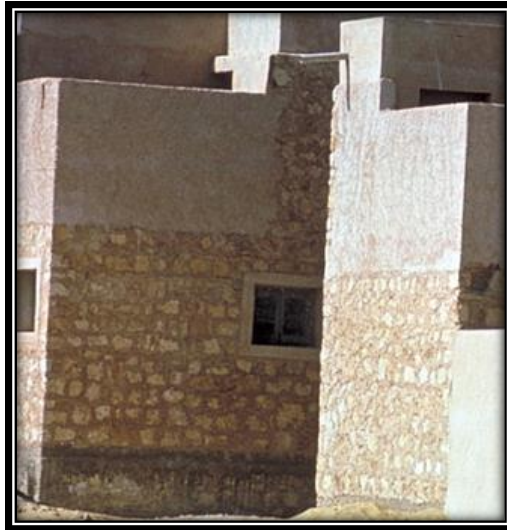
photo qui montre la pierre utilisée ;source André Ravéreau | ALADAR. Site officiel d'André Ravéreau. Consulté le 5 mars 2021, à l'adresse <http://www.aladar-assoc.fr/>
